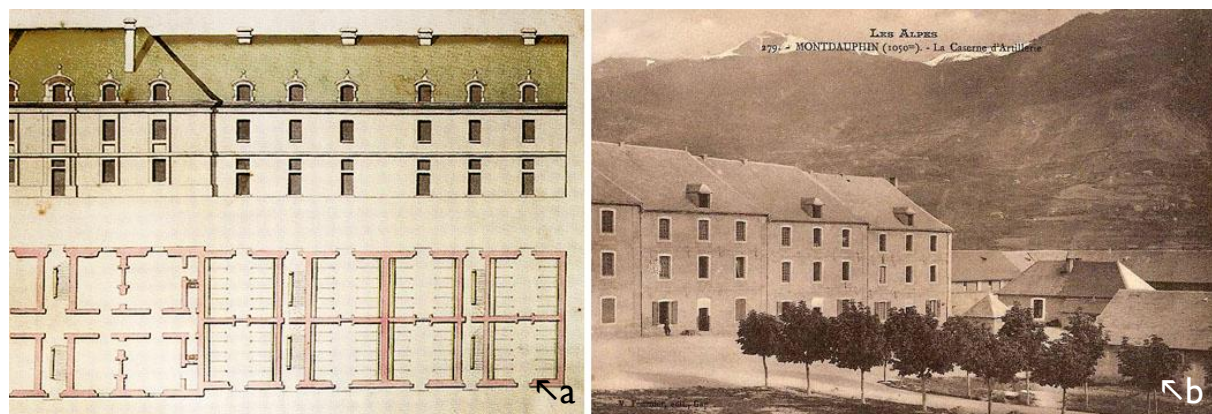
Élévation et plan d'une caserne avec le pavillon des officiers (a) et la caserne Binot de Mont-Dauphin construite après 1700.
